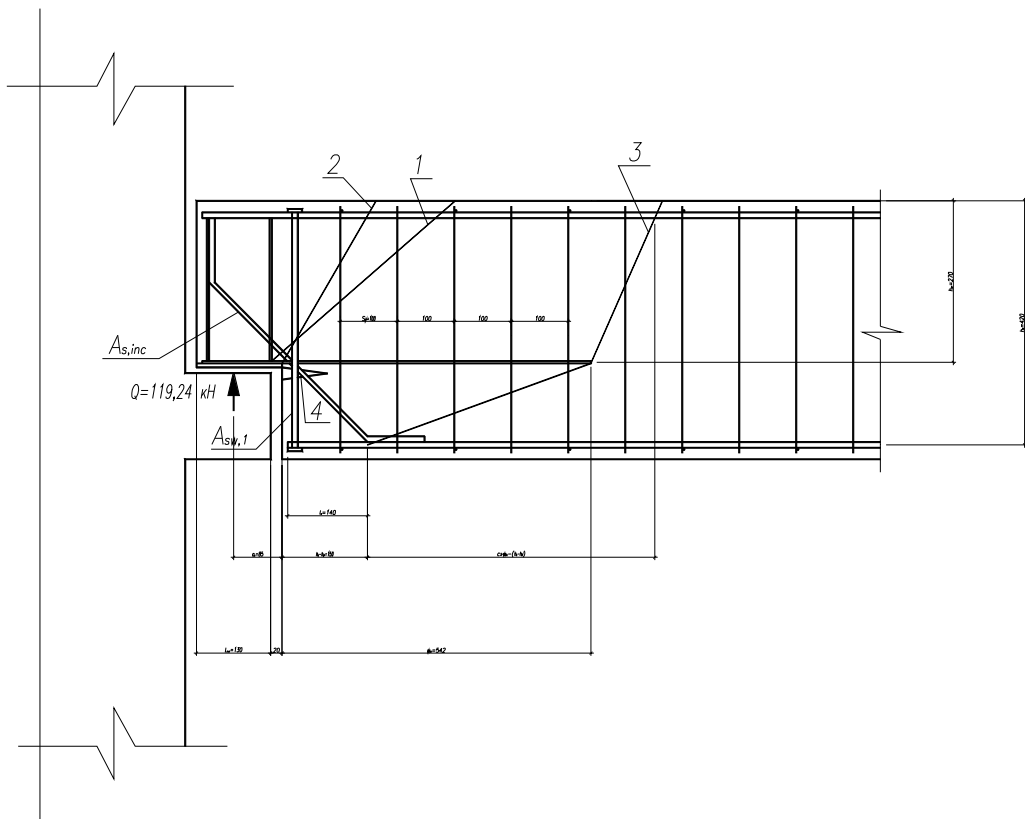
Наклонные сечения на приопорном участке ригеля с подрезкой: 1 – при расчете по поперечной силе; 2 – при расчете по изгибающему моменту; 3 – то же, по изгибающему моменту вне подрезки; 4 – горизонтальная трещина отрыва у входящего угла подрезки.
